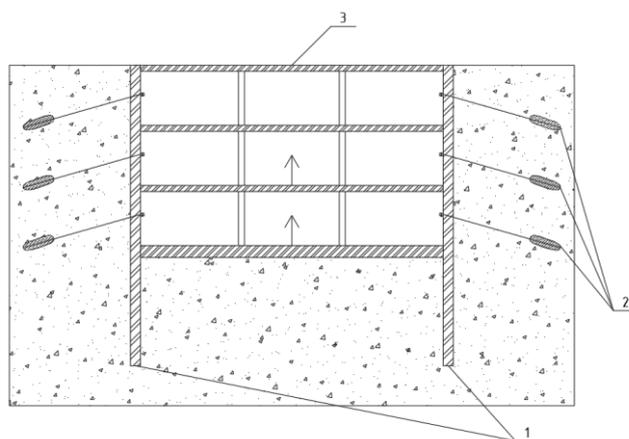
Открытый метод возведения подземных сооружений: 1 – ограждение котлована, 2 – грунтовые анкера, 3 – возводимая конструкция
